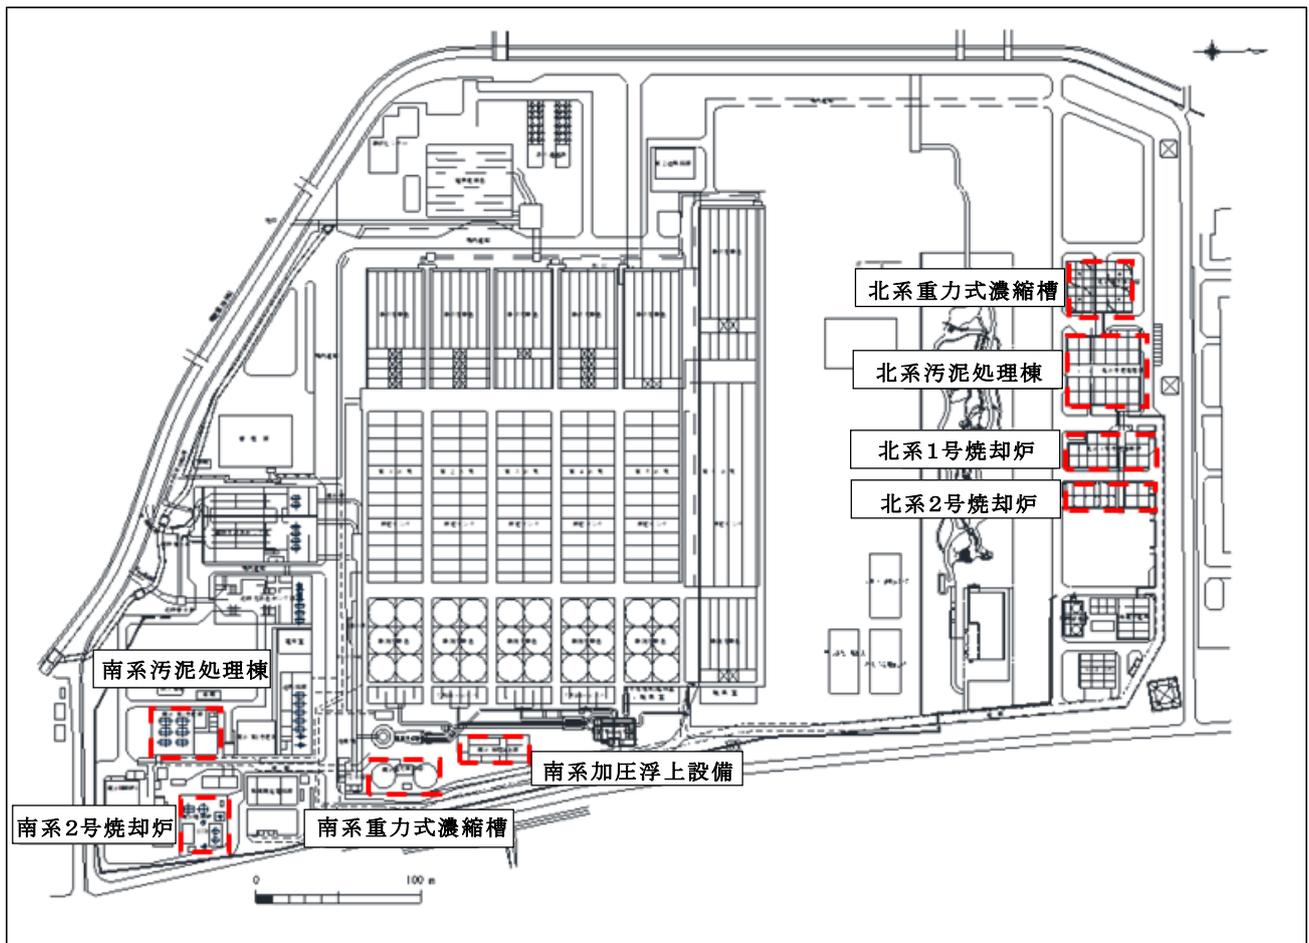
四之宮管理センター平面図（汚泥処理施設位置図）
